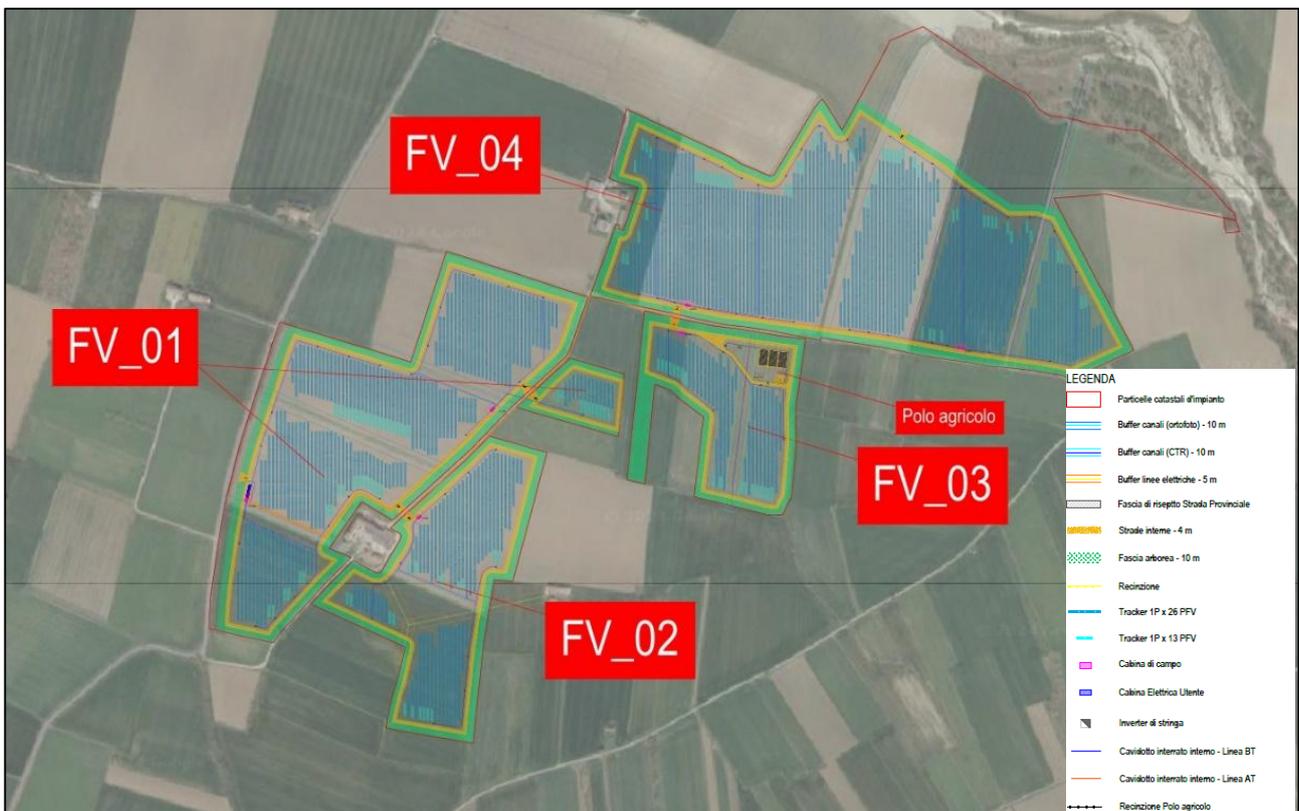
Estratto Layout impianto su ortofoto [VGZPD0T10-00]
